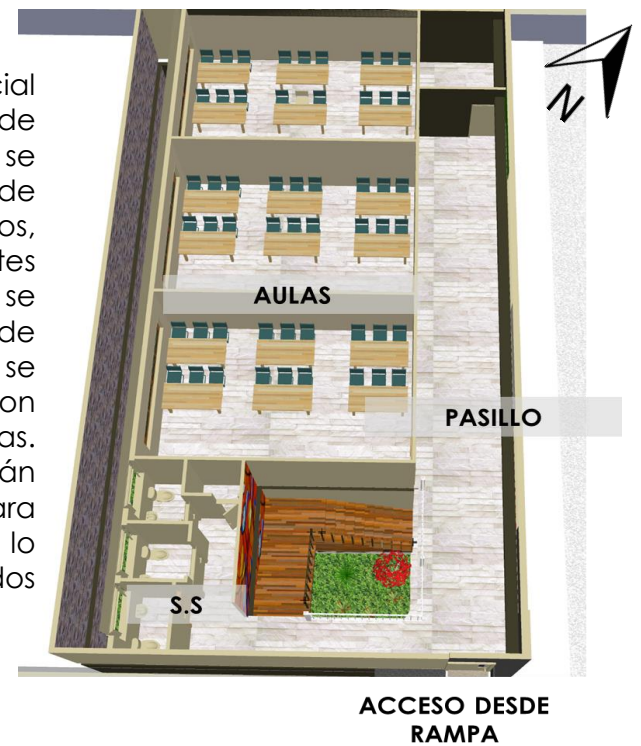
PERSPECTIVA MOSTRANDO LA PLANTA ARQUITECTÓNICA DE SEGUNDO NIVEL
